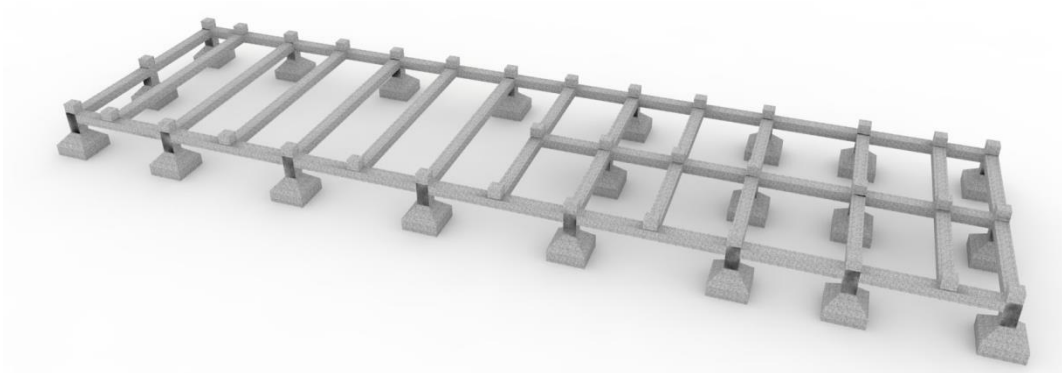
Zapatas y vigas de amarre. Infraestructura.
